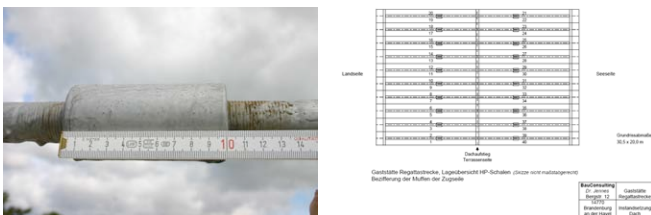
Detailsicht Muffenverbindung der Zugseilkonstruktion (links) sowie Darstellung der Lage der Muffen im Grundriss (rechts)
